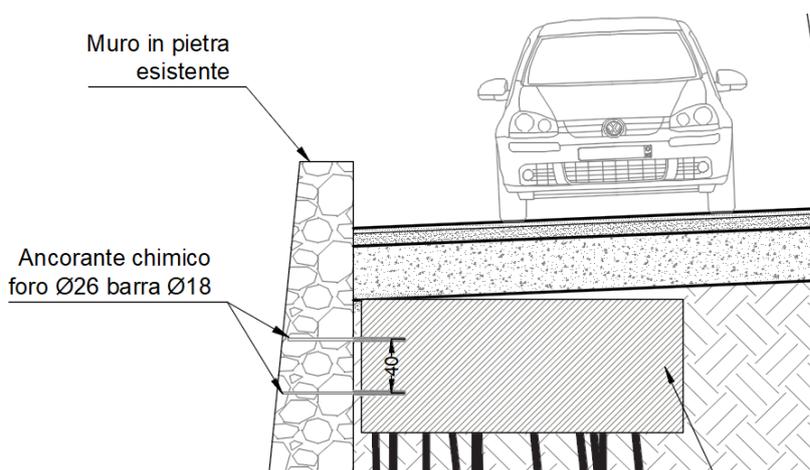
Collegamento in testa del muro con ancoraggi chimici
